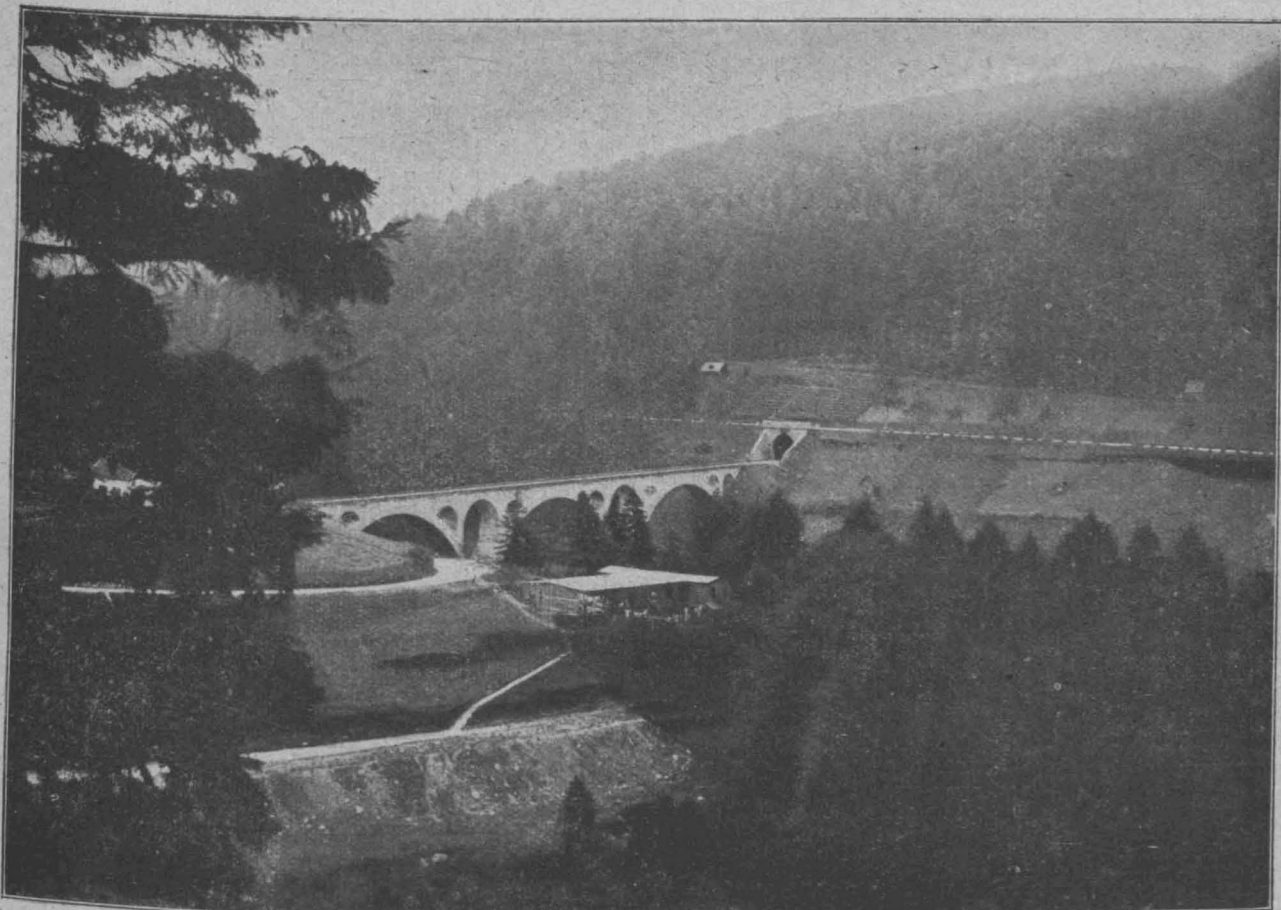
Talübergang bei Forbach. (Rechts Tunnelanschluß.)
